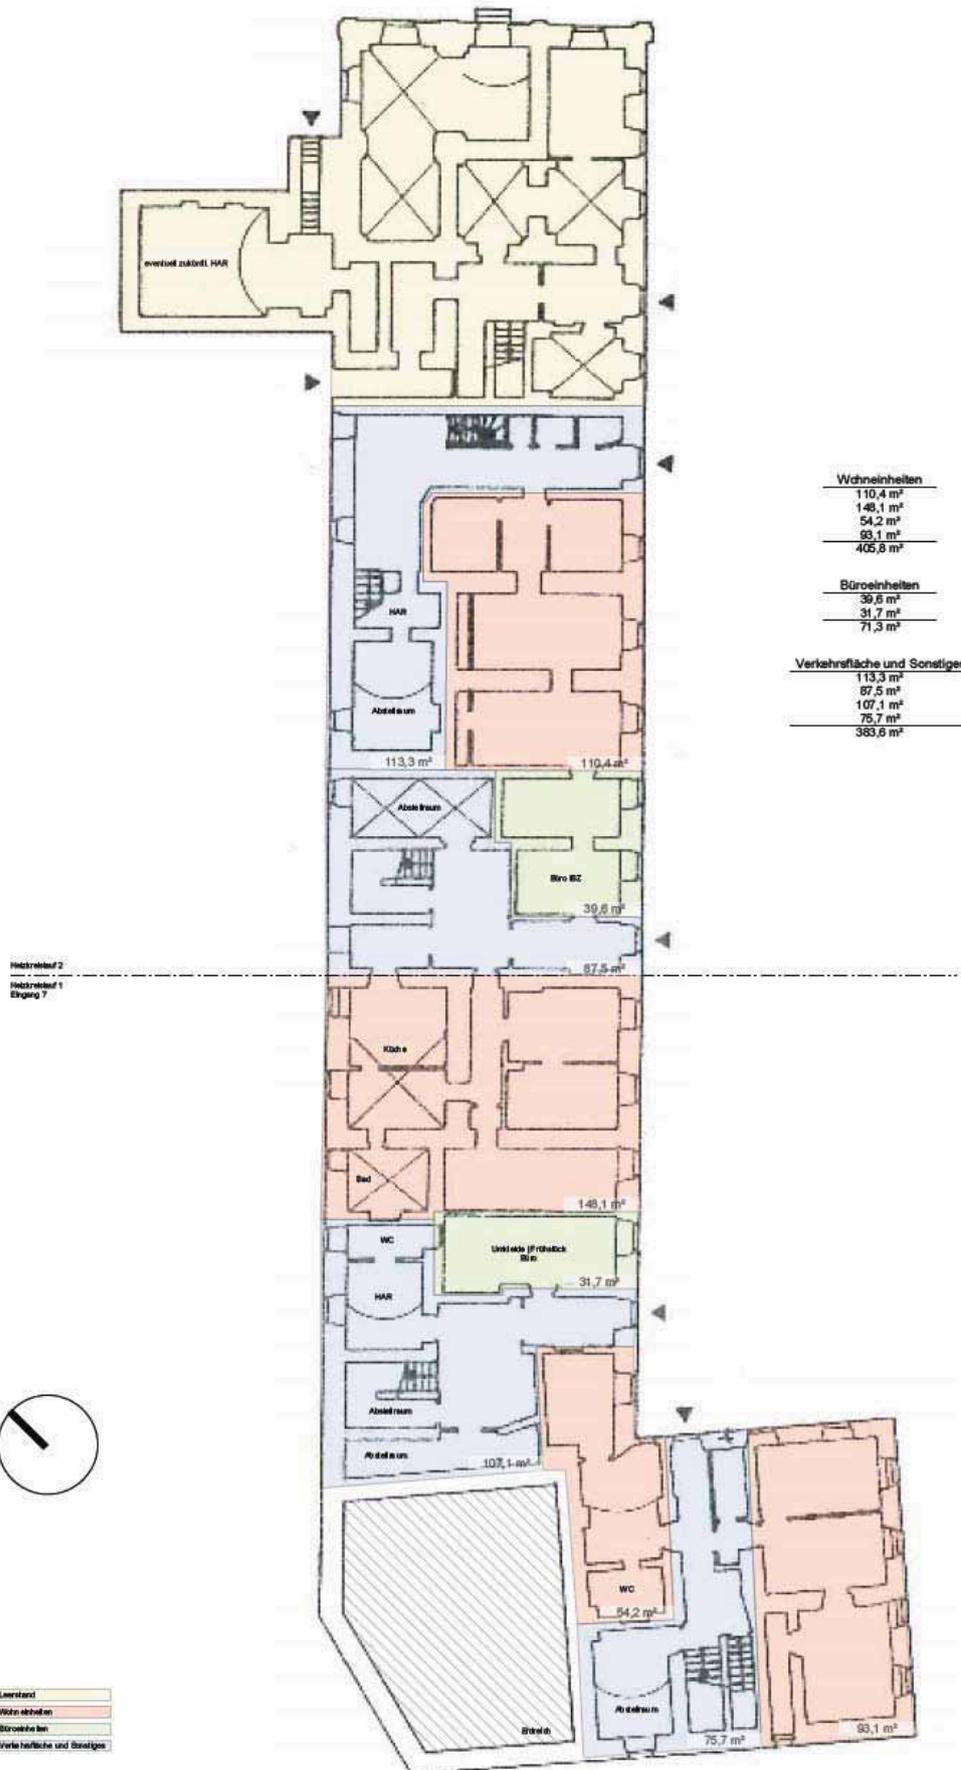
Grundriss EG mit Nutzungszonen
